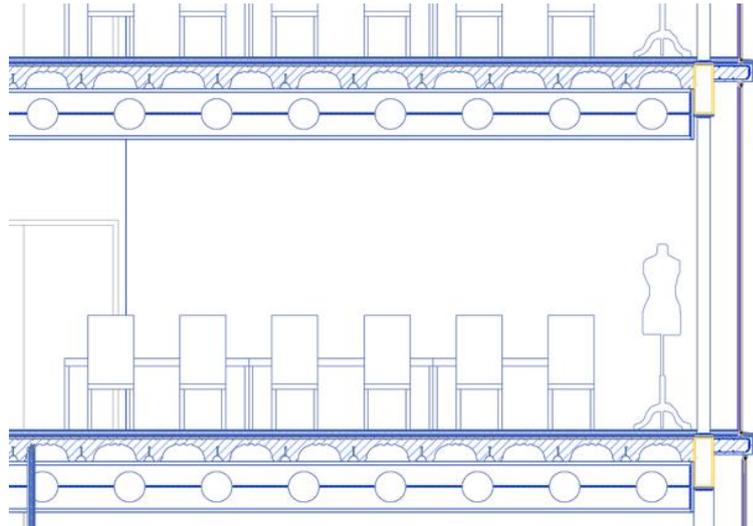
DETALLE FACHADA DE VIDRIO CON LAMAS DE MADERA
